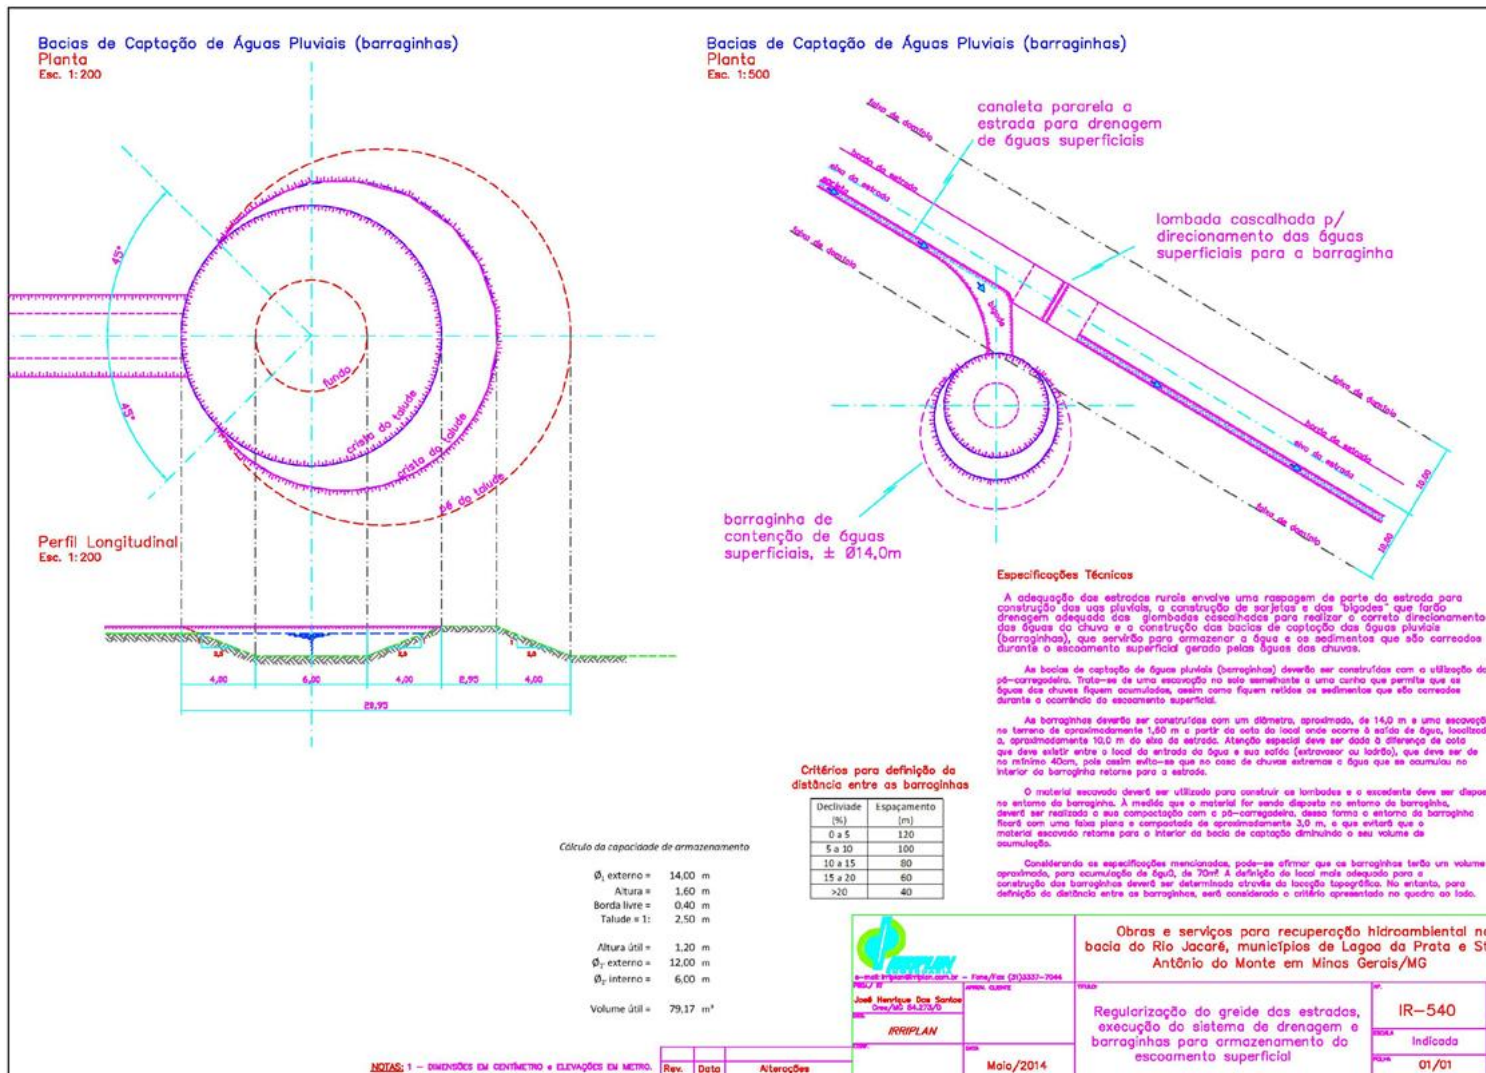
Layout com especificações técnicas para a construção de bacias de captação para drenagem de estradas rurais
